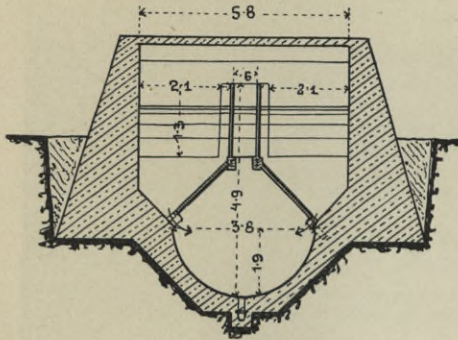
Schematischer Querschnitt einer Faulkammer nach Travis.
